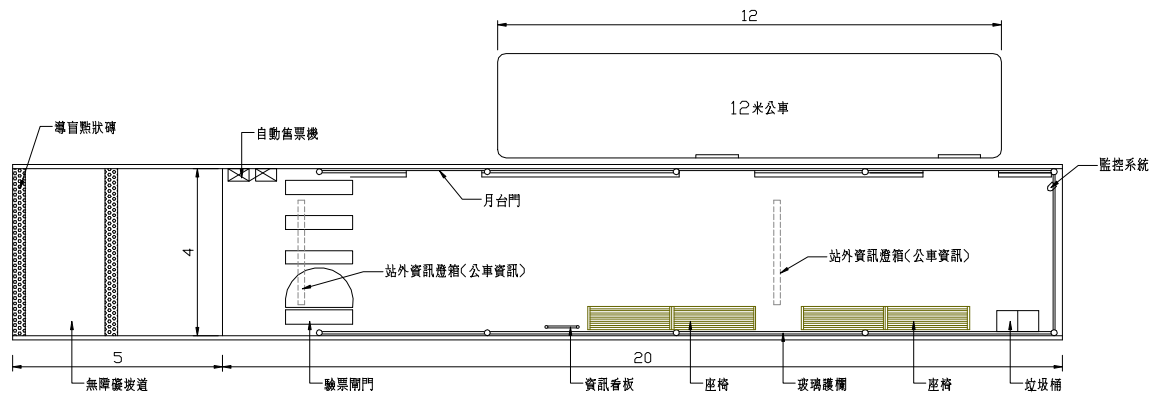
BRT 車站站體(4 公尺寬)平面配置示意圖
